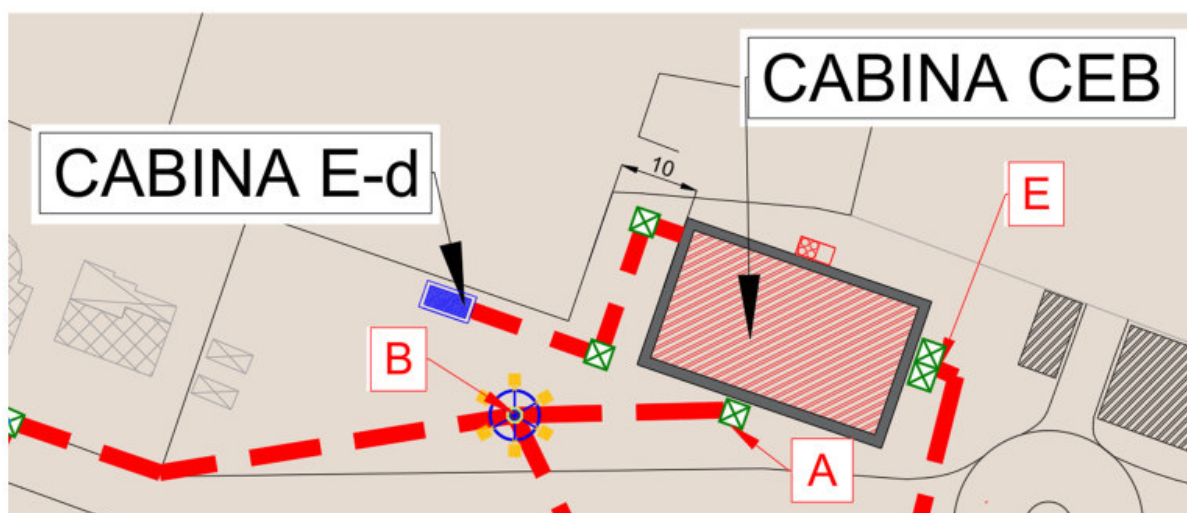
Stralcio della planimetria di progetto della precedente fase progettuale (elaborato 32016019PD0GENDIS03R2)
